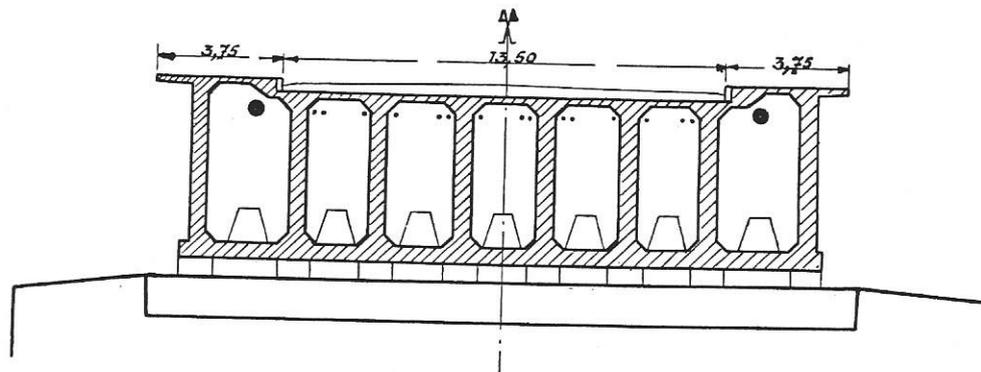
COUPE TRANSVERSALE DU PONT AU DROIT D'UNE PILE.
